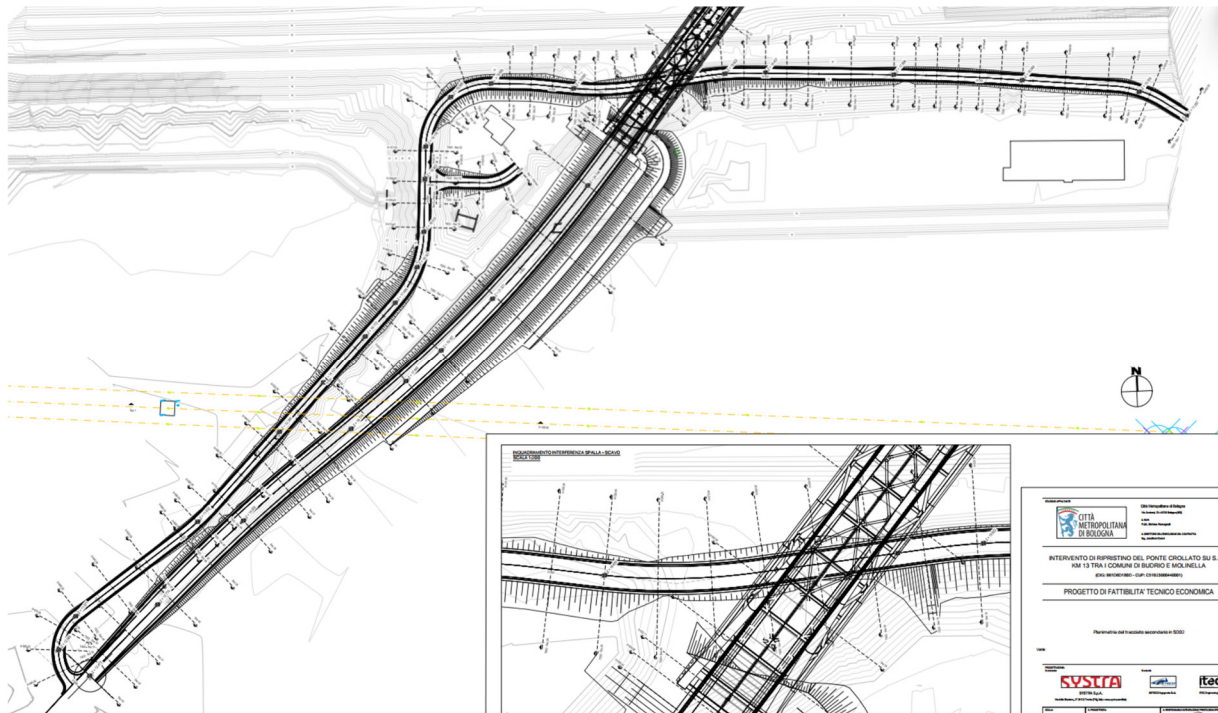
Planimetria del tracciato secondario in sponda destra idraulica
